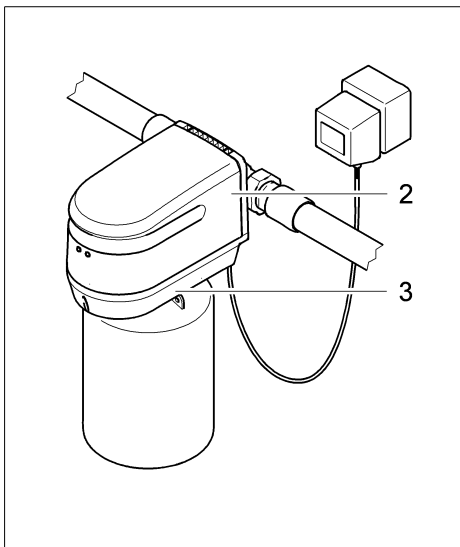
Einbau JJP 3 - 4 mit integriertem Wasserzähler
